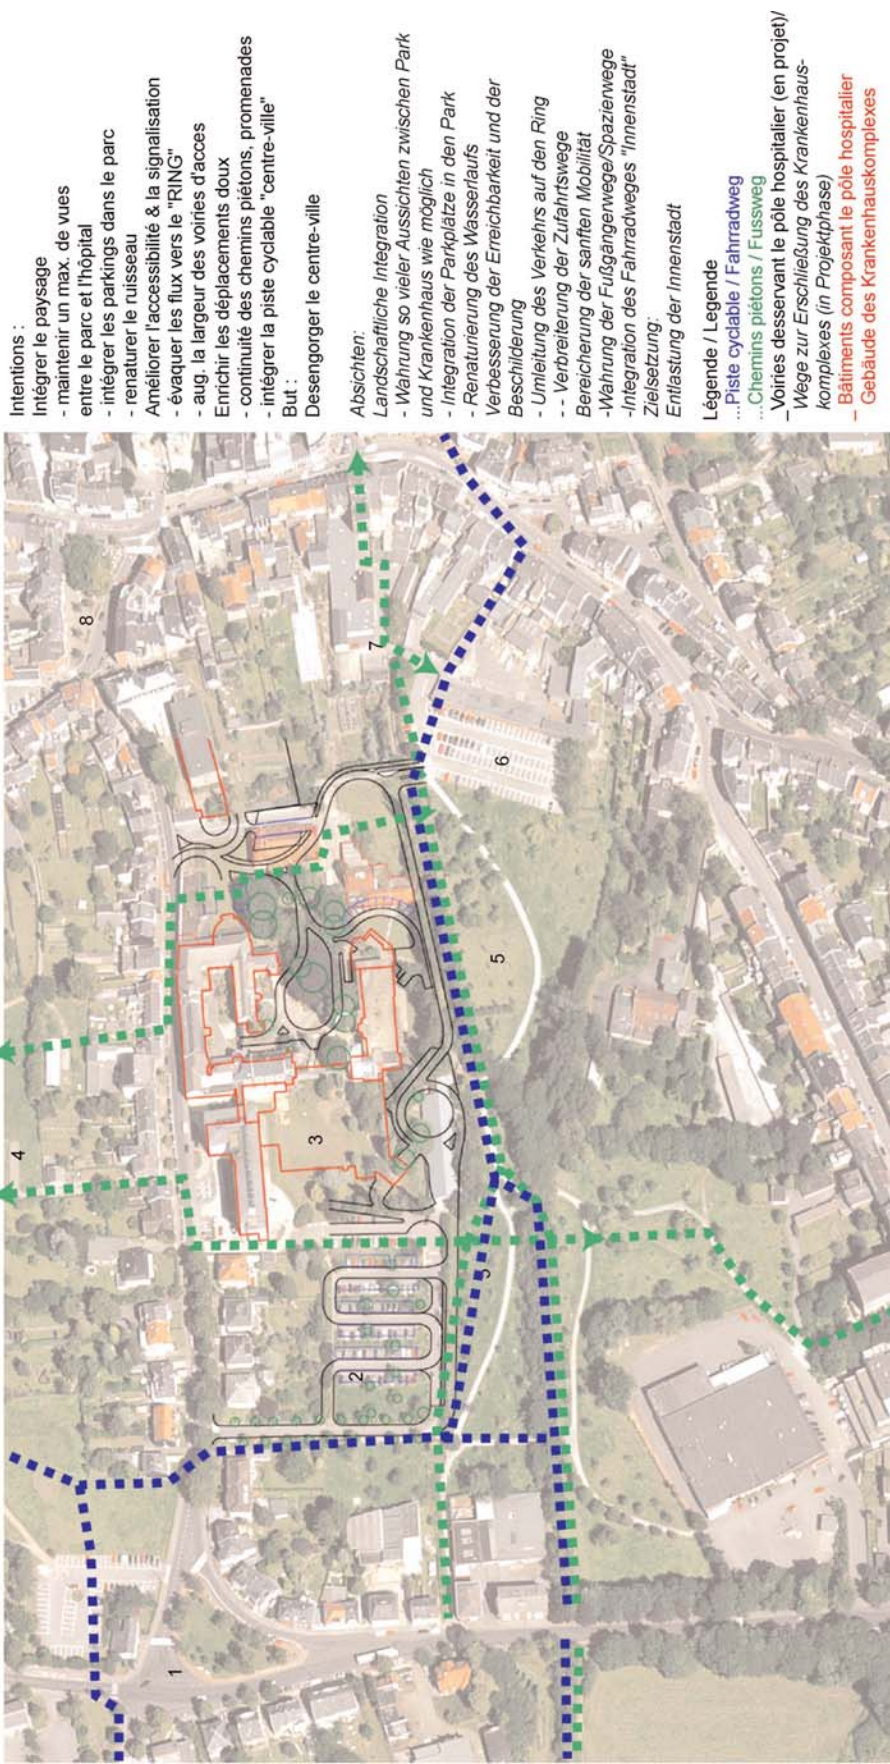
Parking Paveestraße - Proposition de réaménagement
